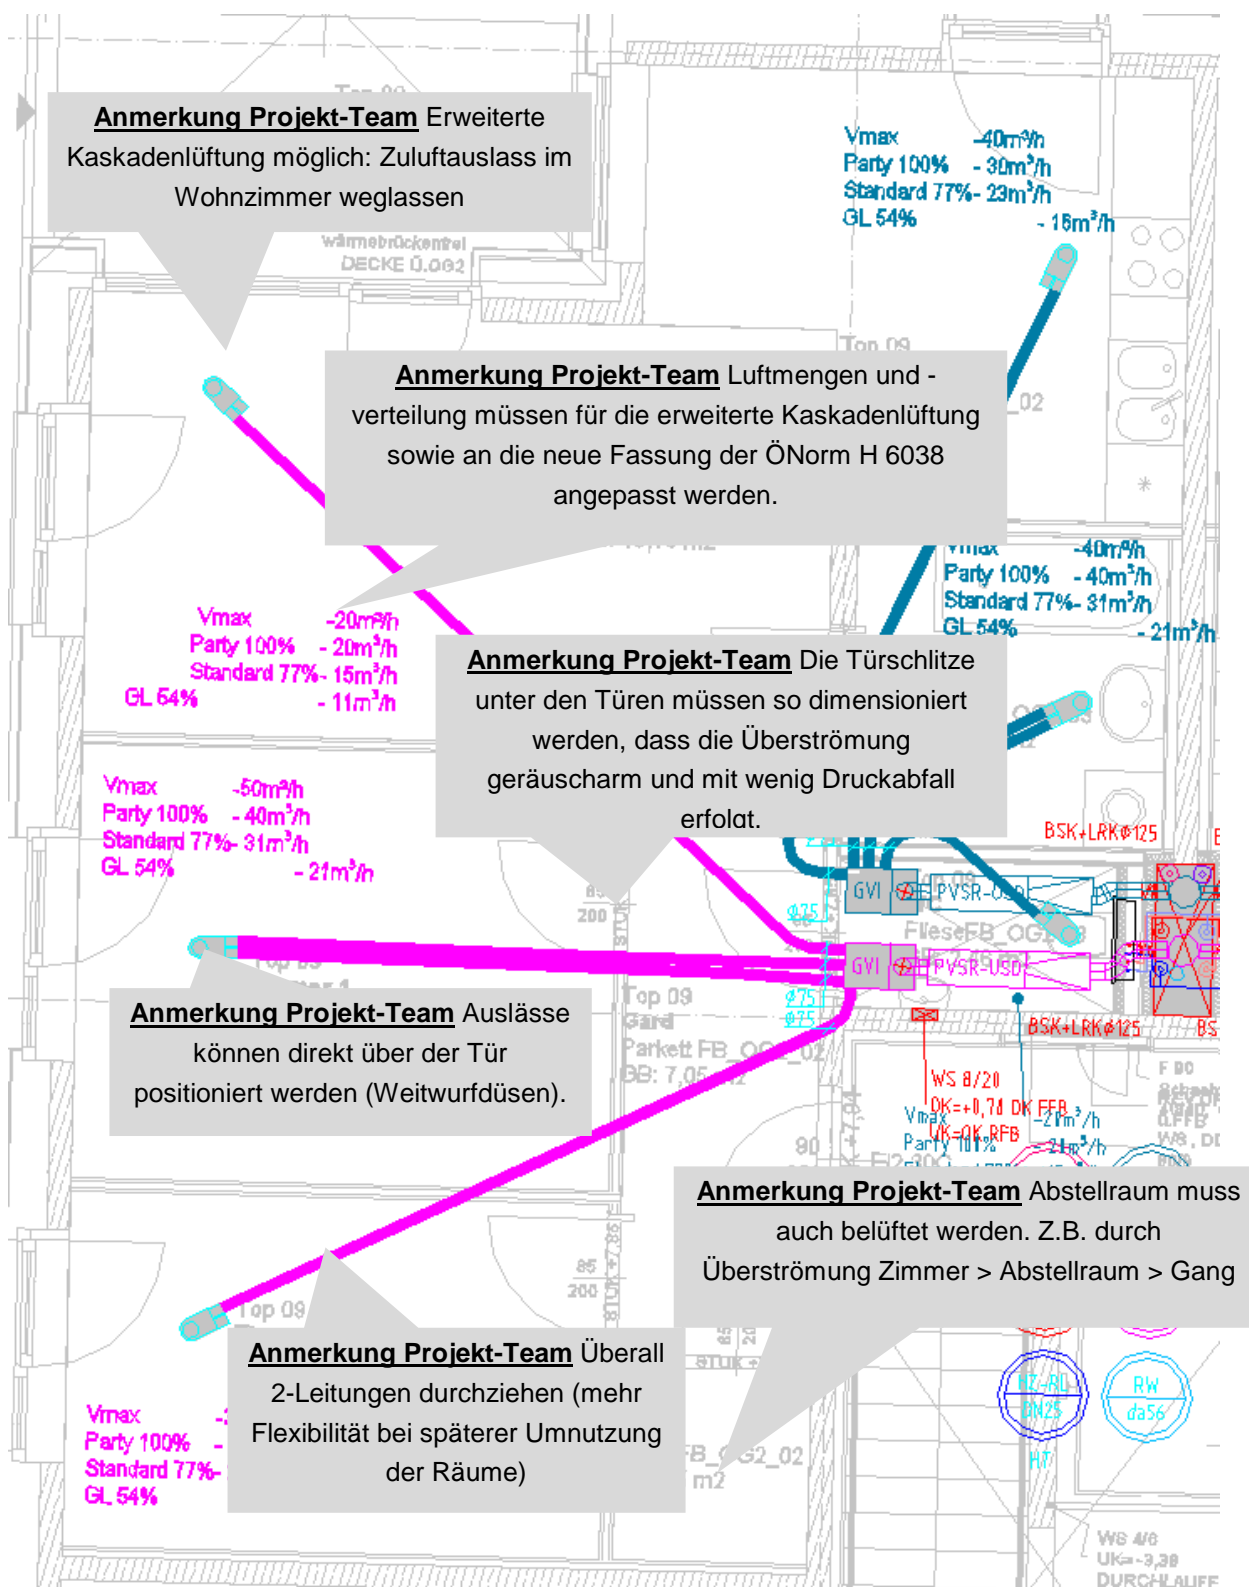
Detail aus dem Plan ACAD-30G\_HLS.dwg vom HLS Planung, Stand 10.04.2013
